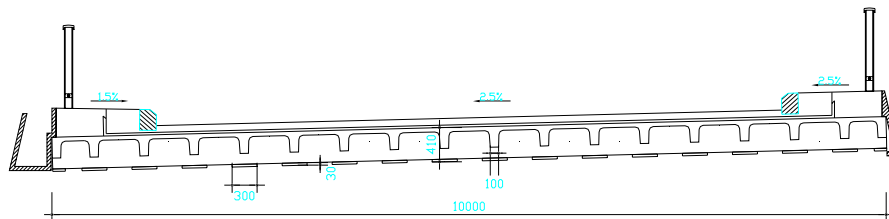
Coupe transversale - solution 10m - Dalle BFUP gaufree-échancrée et semelles en acier
